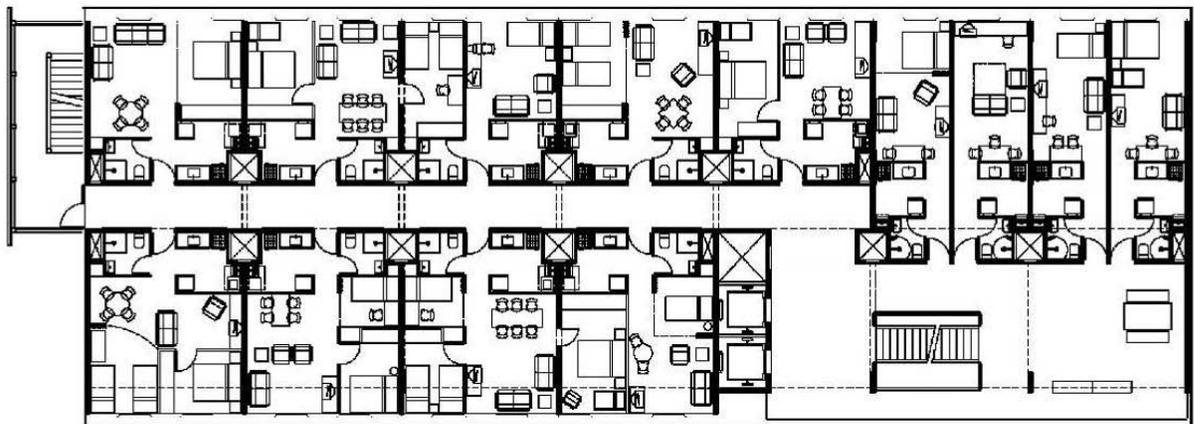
Pavimento-tipo com layout sugerido (s/esc).
